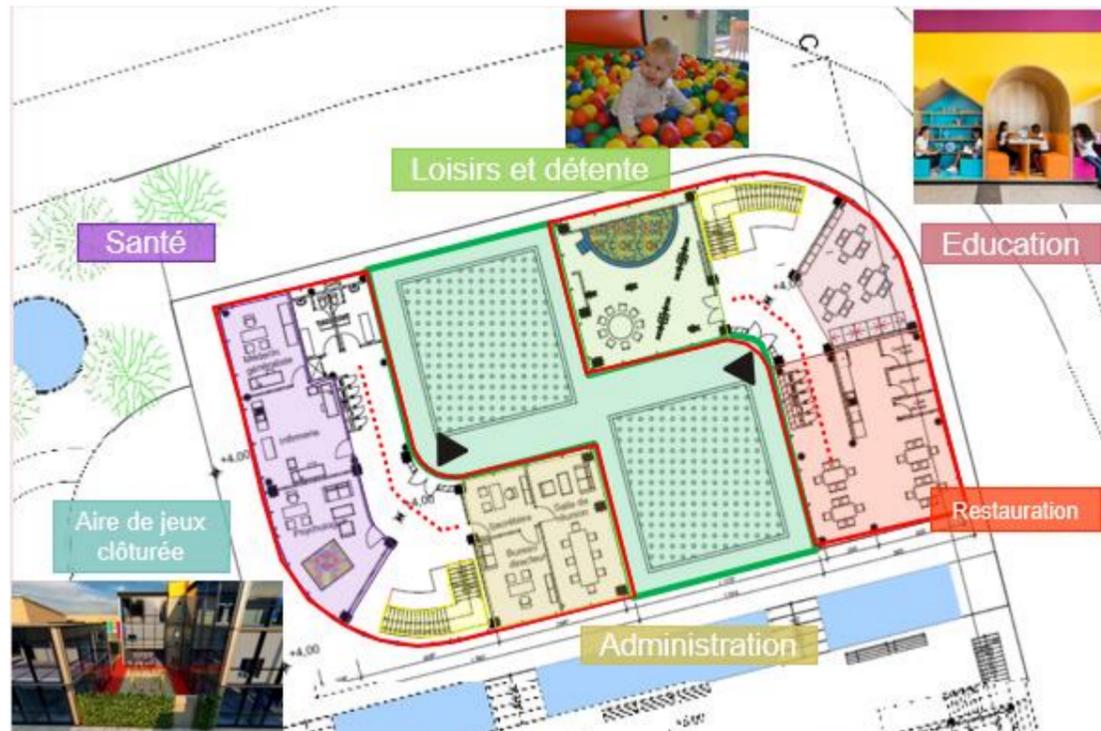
Plan du rez-de-chaussée – Foyer des enfants
